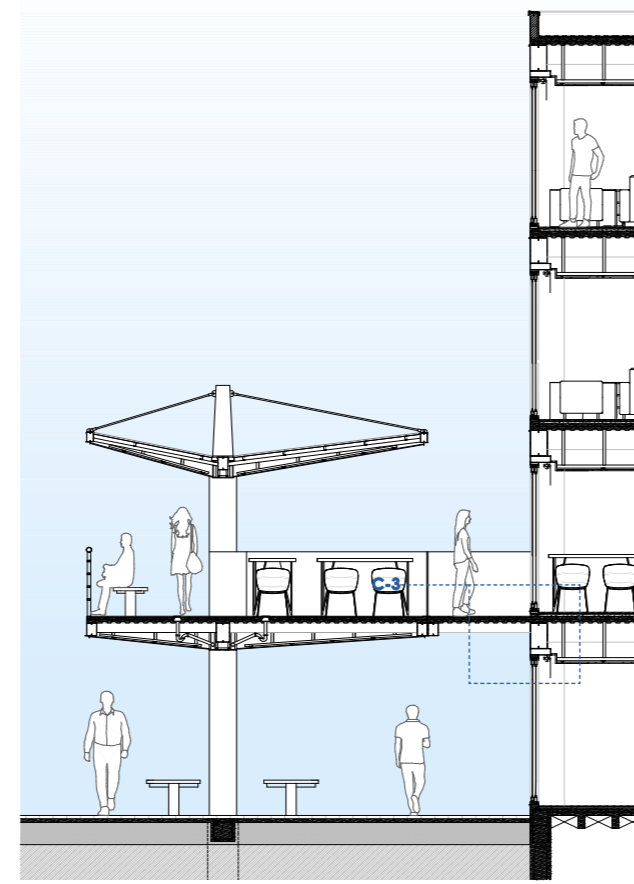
Sección Constructiva S-1-Detalle C-3. Fuente: Elaboración propia (2026)
